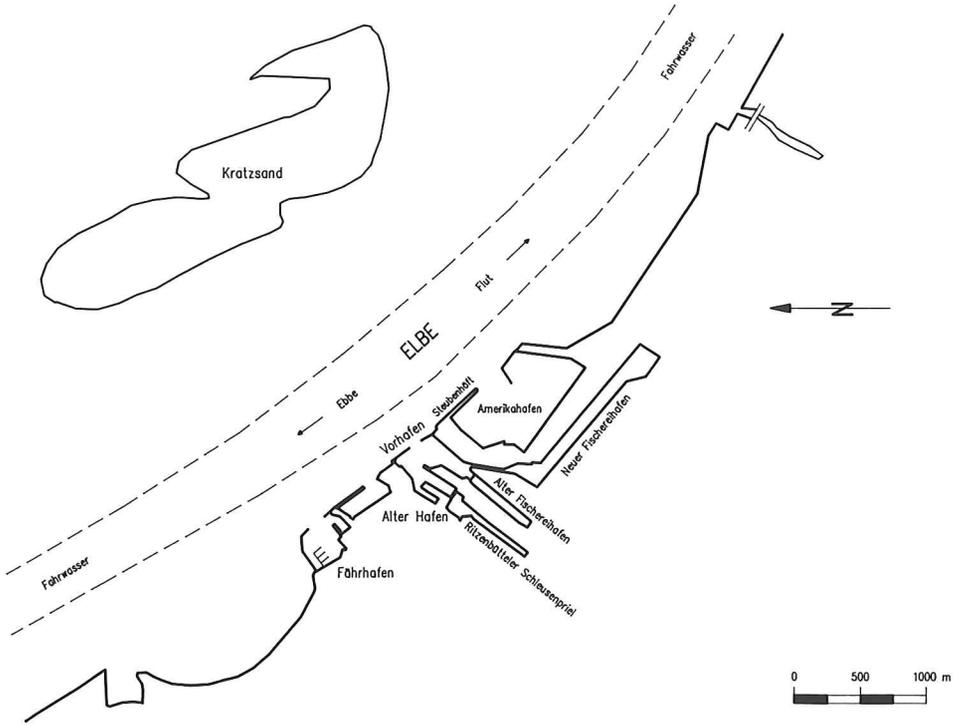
Hafenanlagen in Cuxhaven, Lageplan
